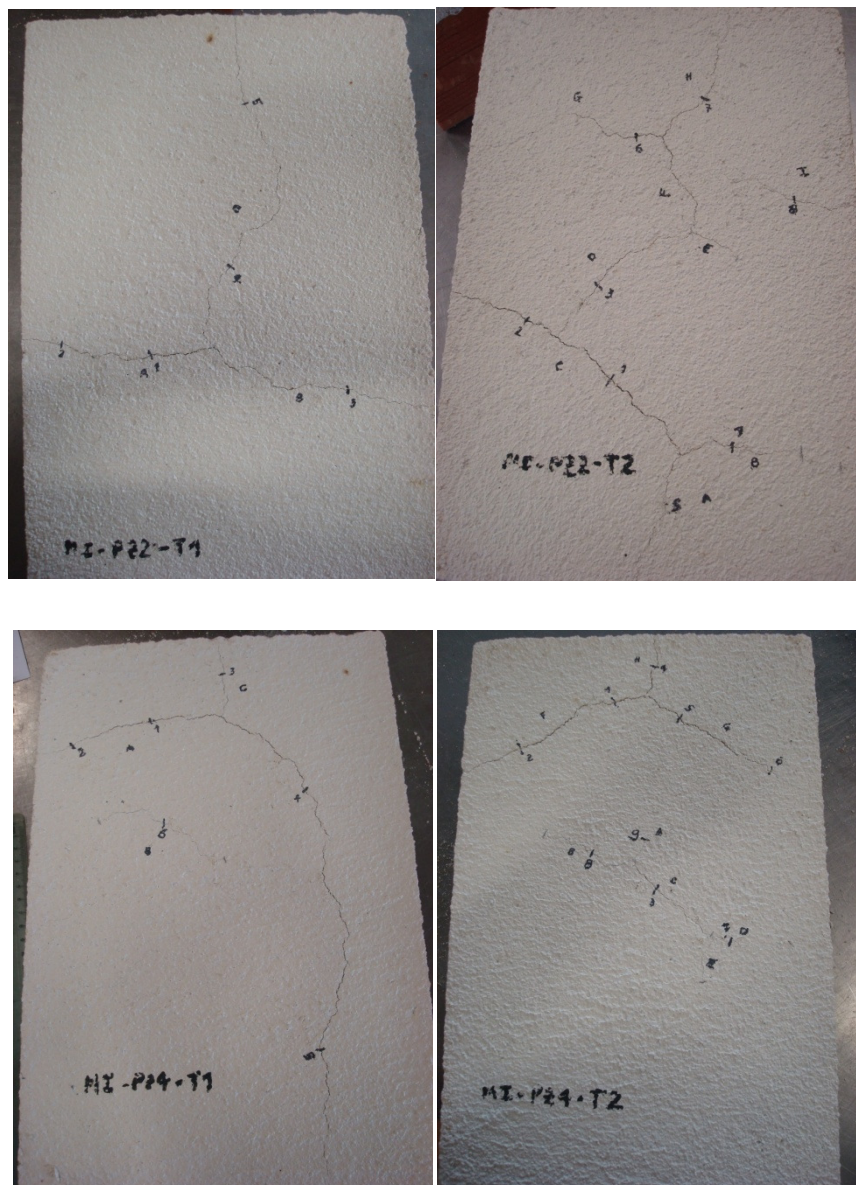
Mapeamento da fissuração nas argamassas aplicadas como camadas de revestimento de tijolos, PZ2 e PZ4.
